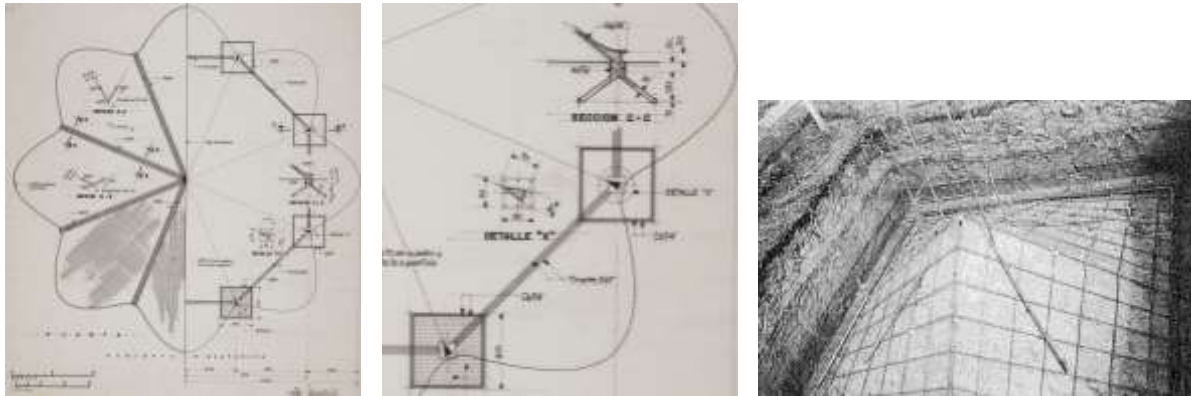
Izq: Solución estructural de los Manantiales, donde pueden apreciarse dos secciones de la viga parabólica en V que recorre las aristas. Centro: Detalles de la cimentación y el apoyo tipo. Der: Cimentación utilizada regularmente por Candela, con cuatro segmentos de paraboloides hiperbólicos modelados en el piso. (Plano: FCA-CU. Foto: AAM-FA UNAM)
